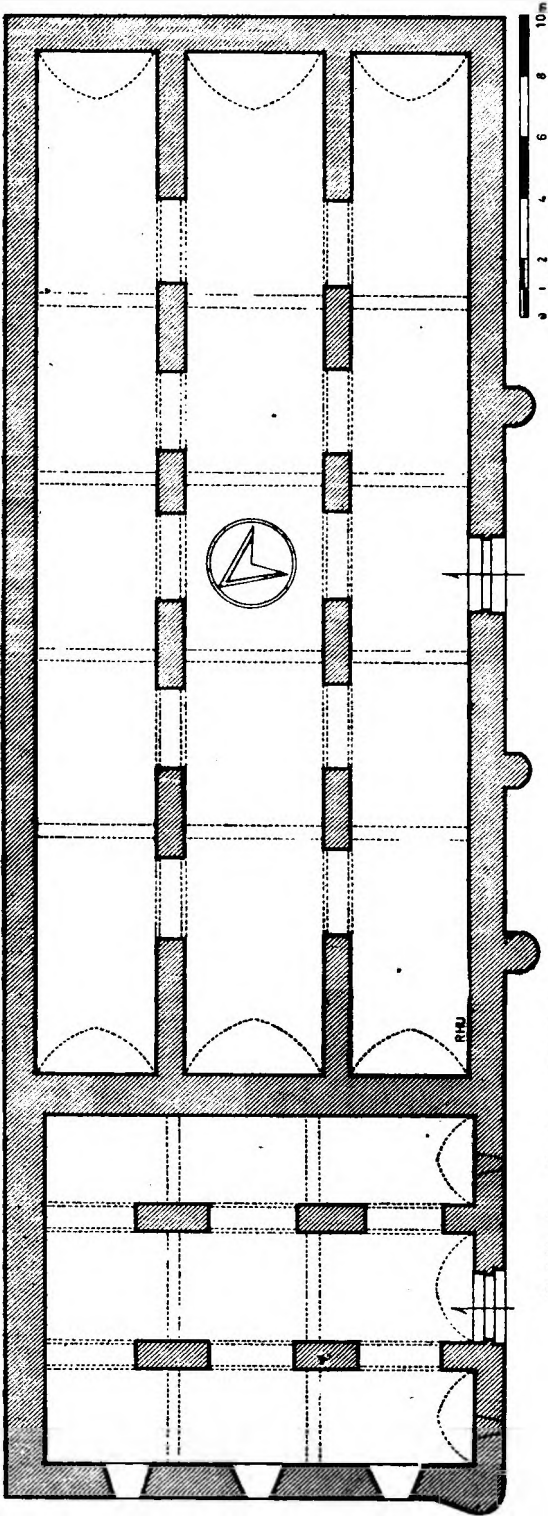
Dumluca Hanı (Divriği-Sivas) Plan.
